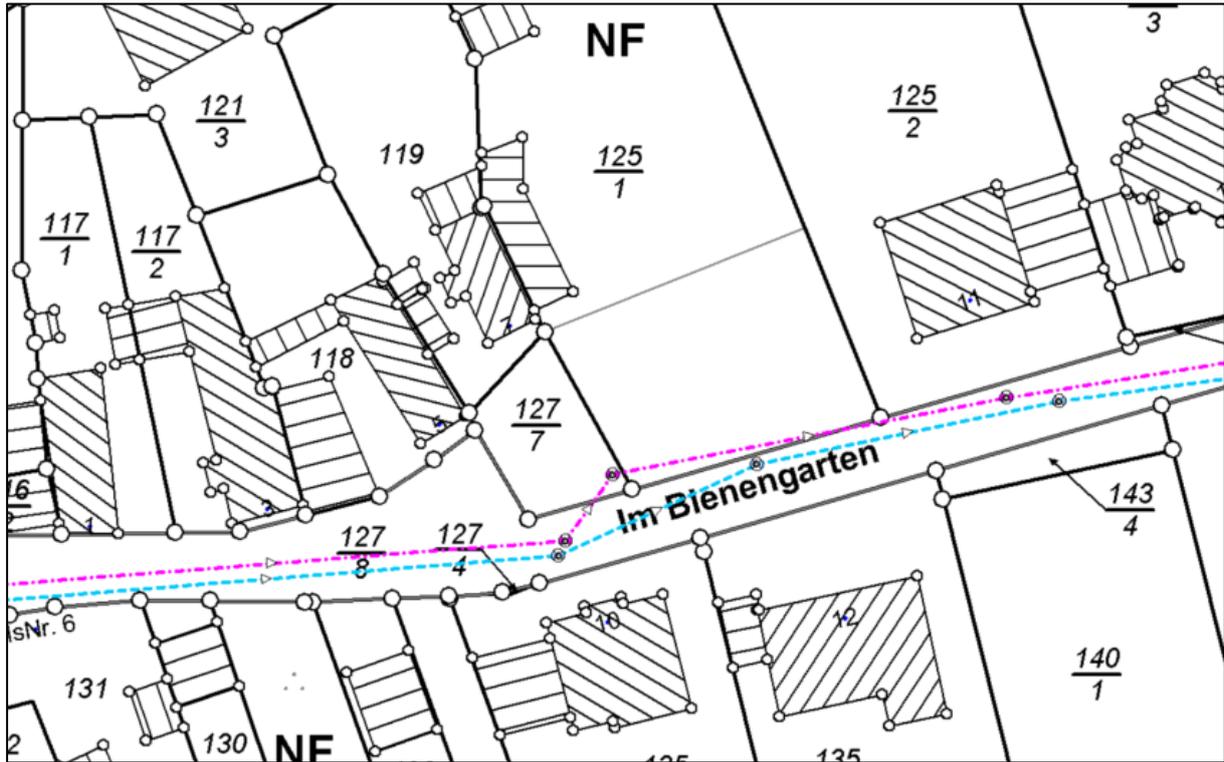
Kanaltrassen im Bereich des Bebauungsplans
